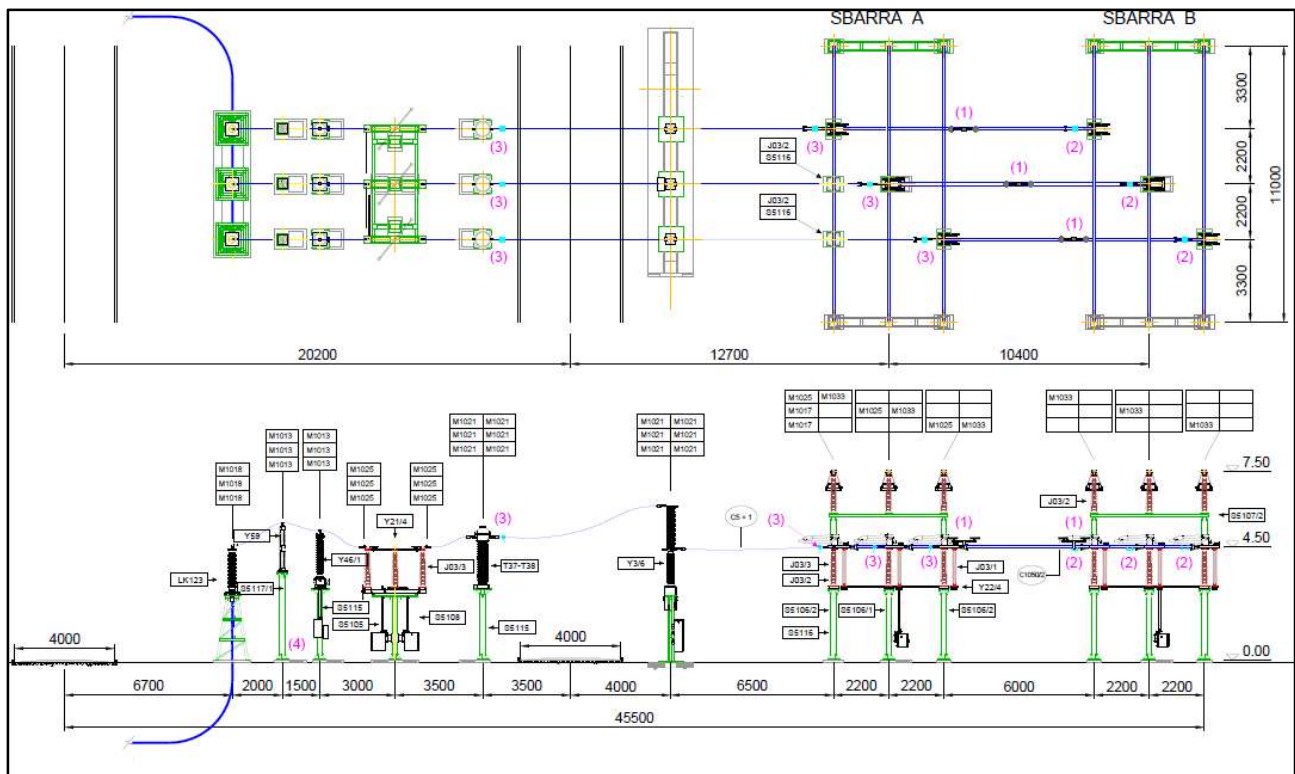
Planimetria e sezione elettromeccanica relativa alle apparecchiature dello stallo 150 kV nella stazione Terna
